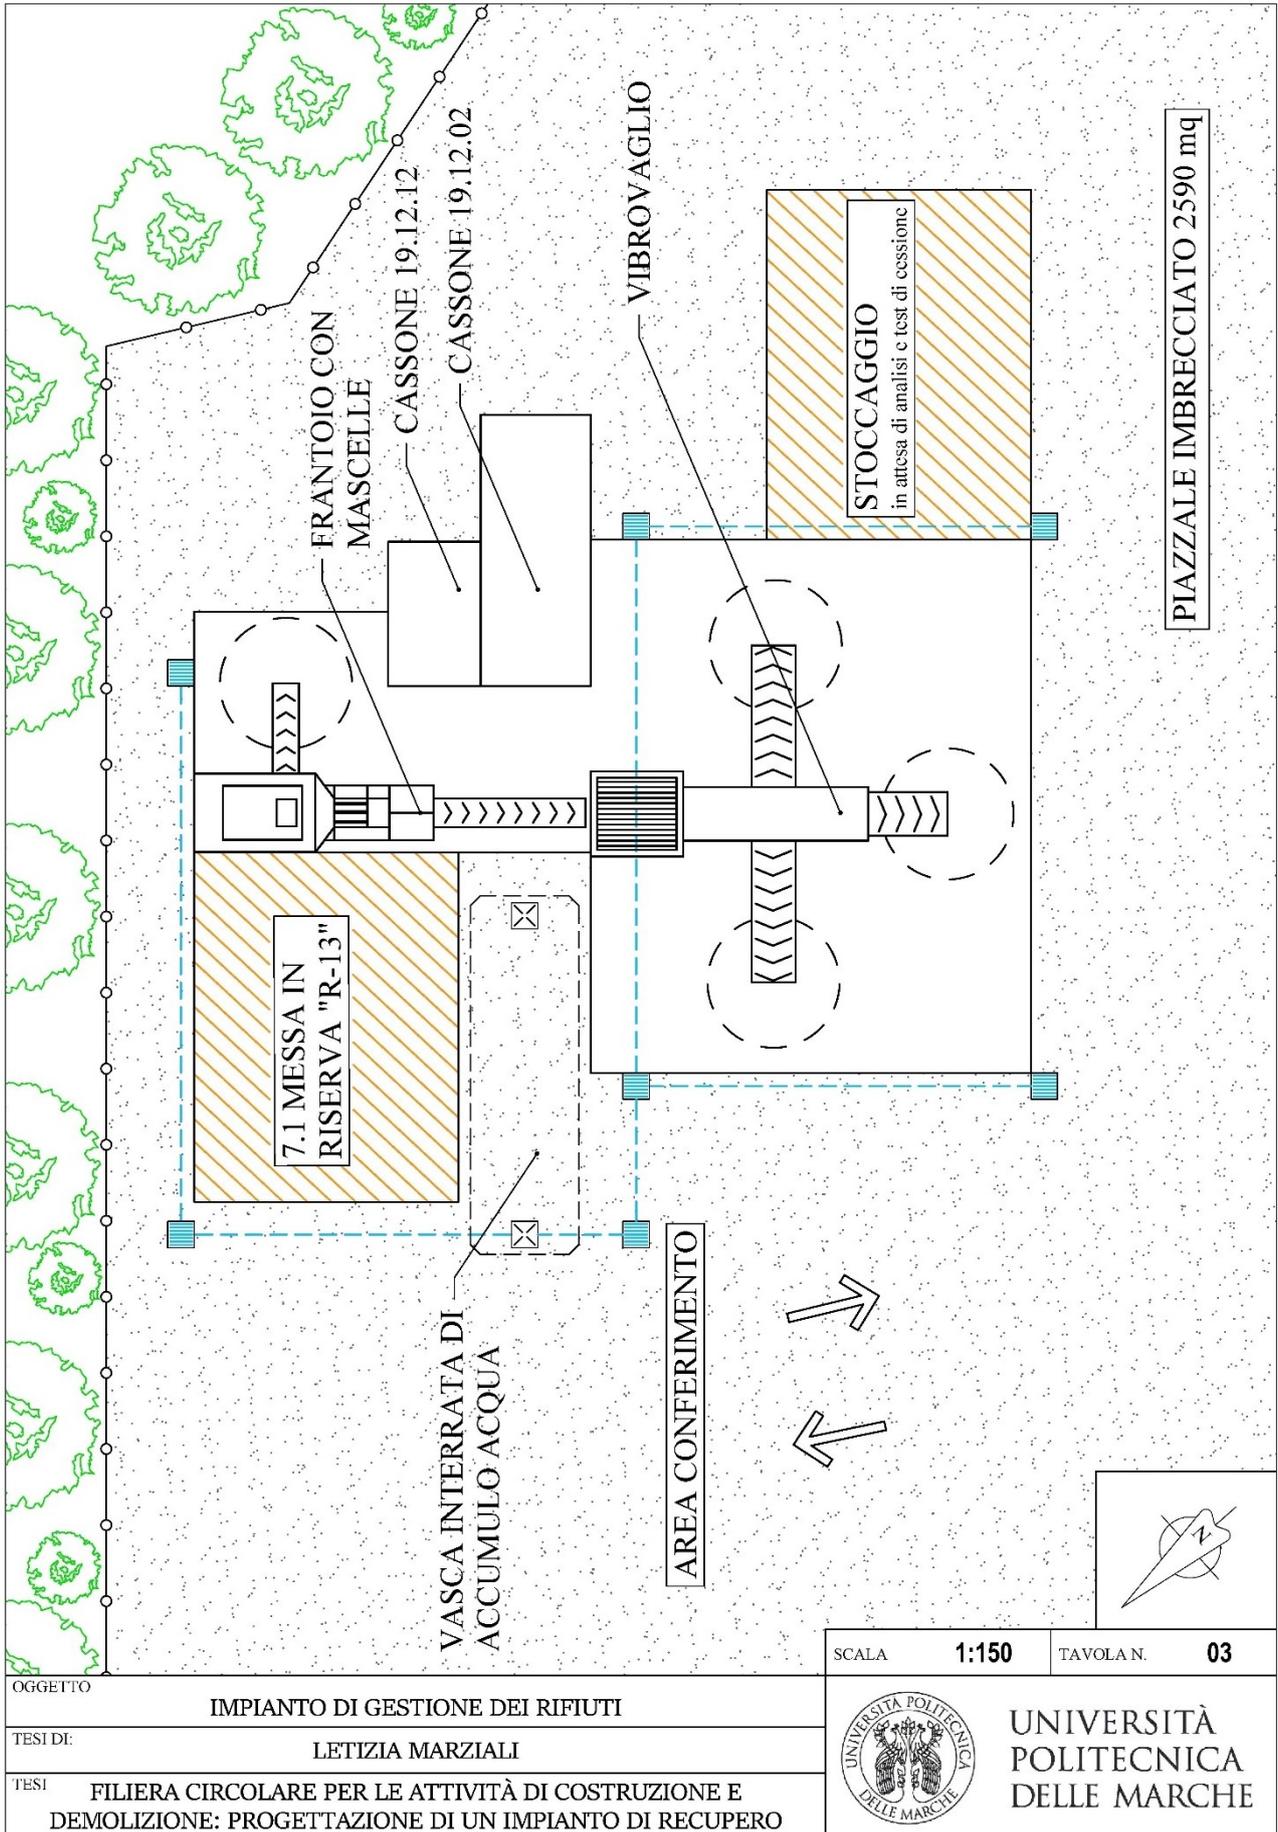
Planimetria dell'impianto di gestione dei rifiuti
